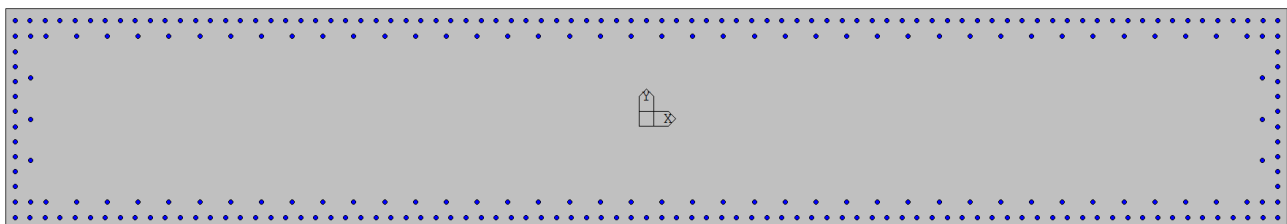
Disposizione armatura longitudinale sul fusto della pila
